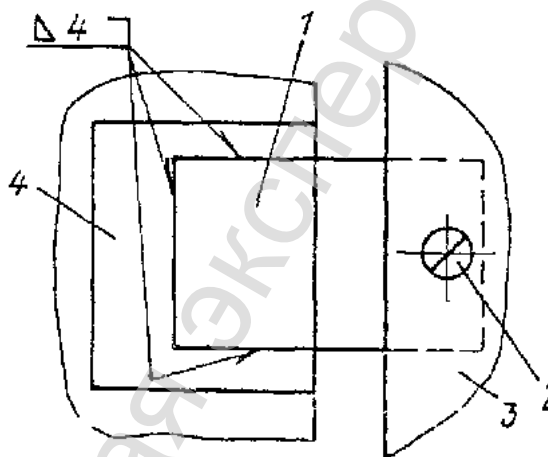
Крепление обрамлений дверных проемов к закладным деталям шахты:
